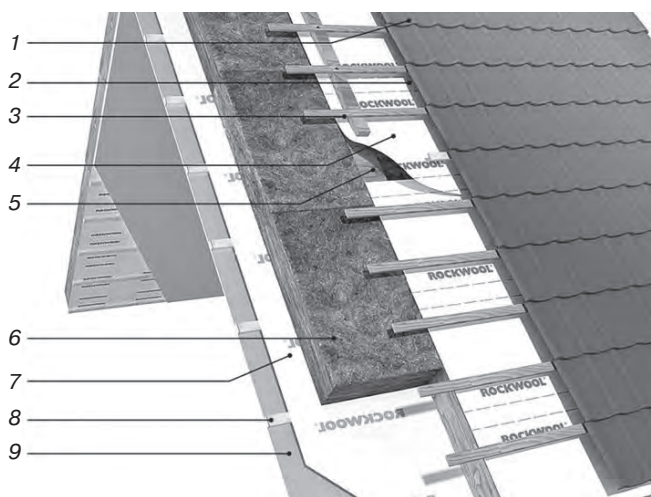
Конструкция утепленной кровли над мансардой [3]: 1 – кровельное покрытие; 2 – вентилируемый зазор; 3 – обрешетка и контробрешетка; 4 – диффузионная мембрана; 5 – стропила; 6 – минеральный утеплитель; 7 – пароизоляция; 8 – обрешетка; 9 – внутренняя обшивка
